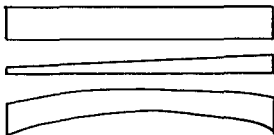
FORMAS TÍPICAS DE VIGAS DE MADERA LAMINADA.
